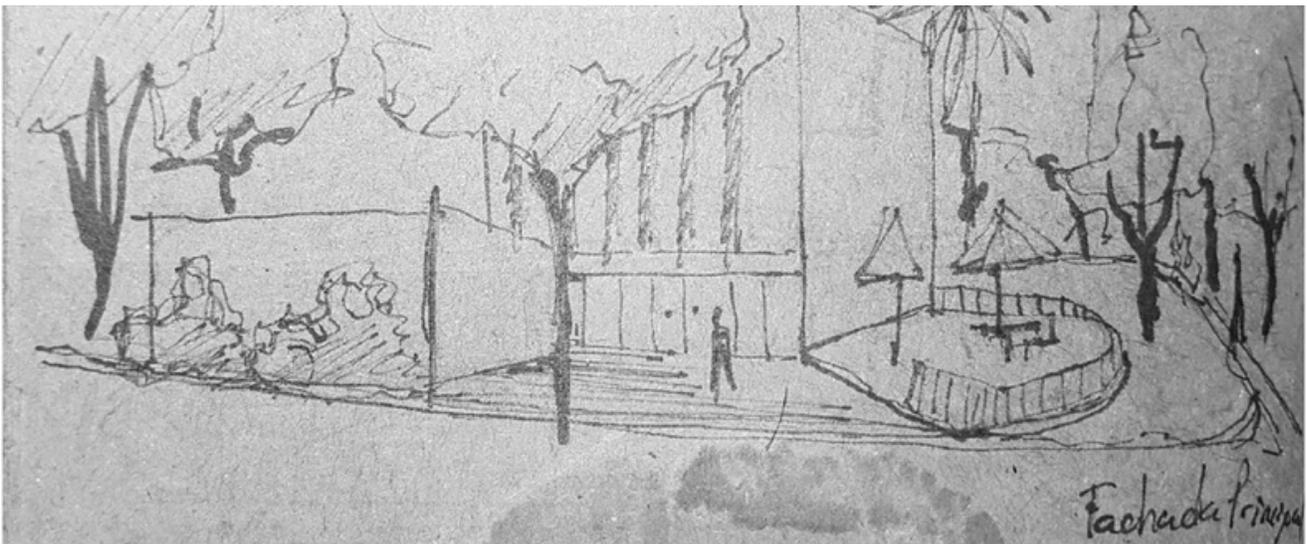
Croquis conceptual, perspectiva de fachada principal. Fuente: Autoría propia
